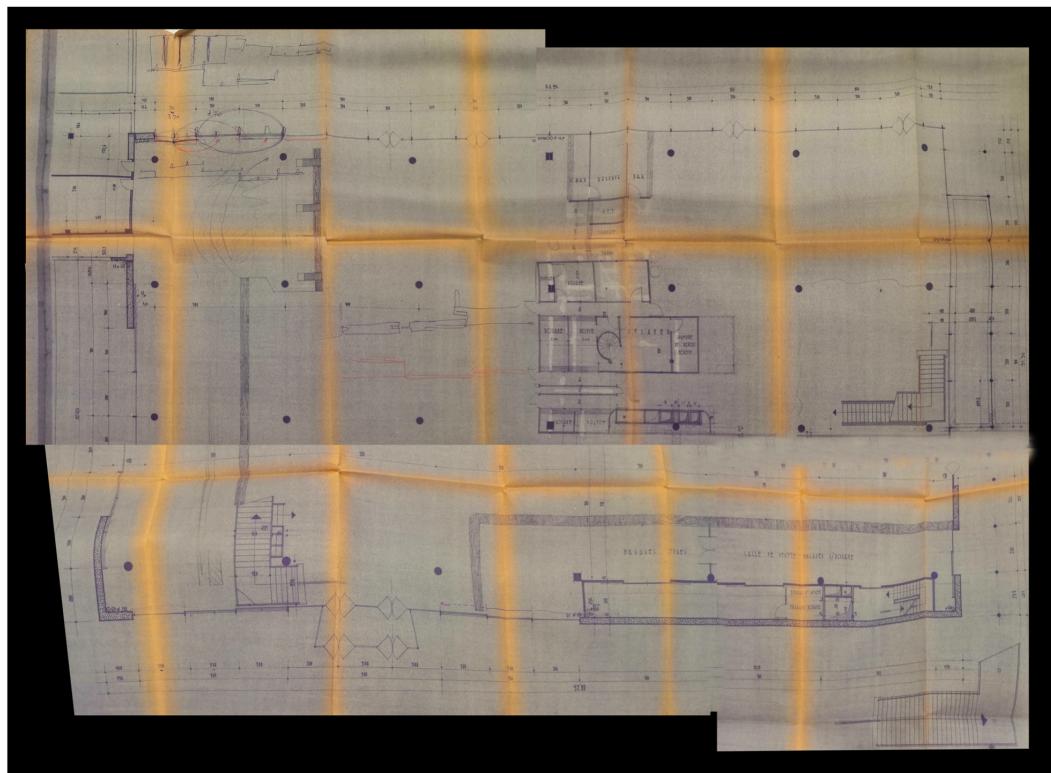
Plan du premier étage, aérogare de Lyon-Bron, architectes : Bathellier, Mourey et Jolivet, 1957
